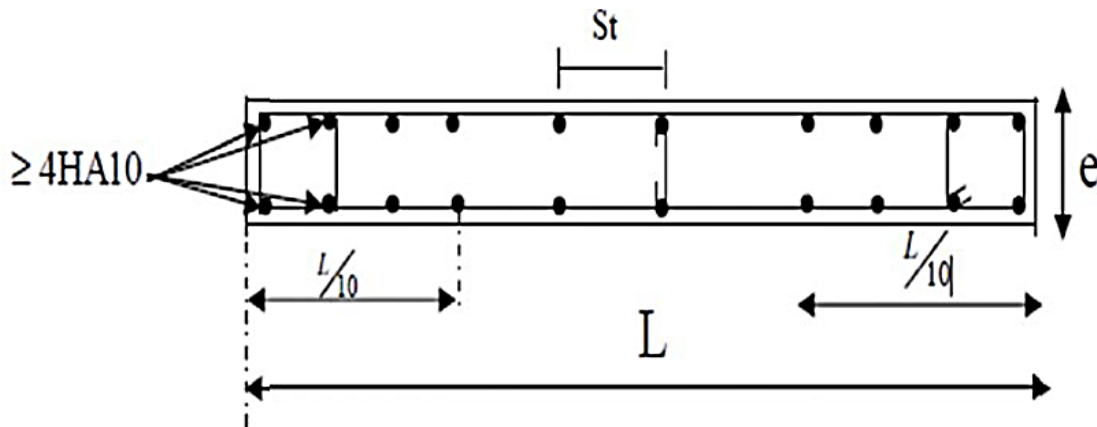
Disposition des armatures verticales dans les voiles.
